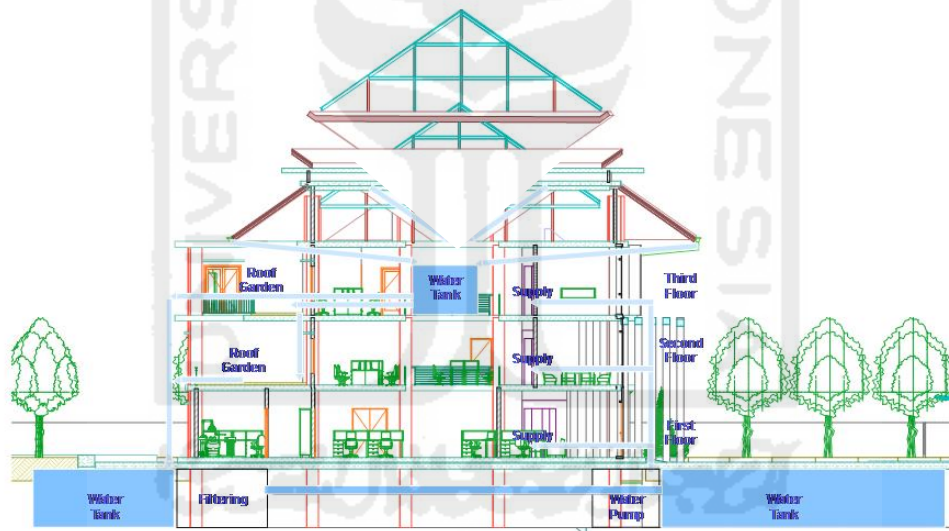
Gambar Rancangan Struktur pada Bangunan
